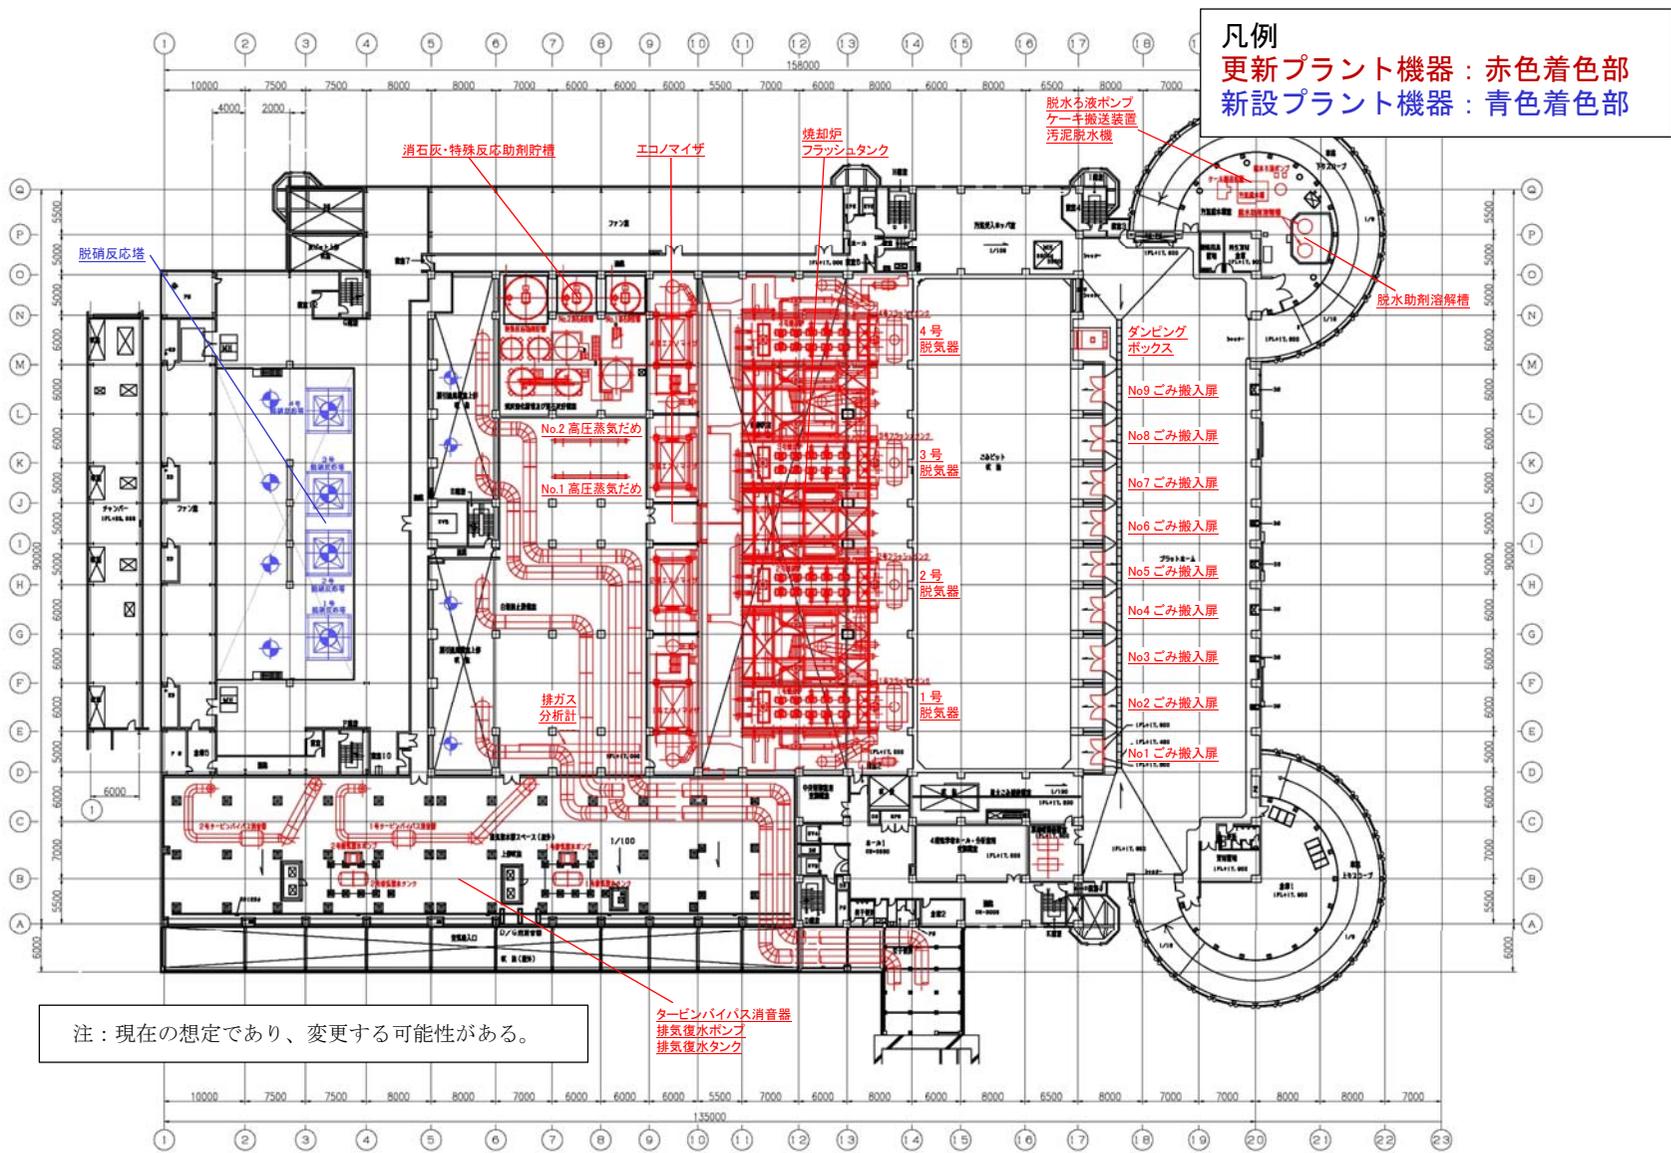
(5) 設備機器の更新箇所 (5階平面図)
